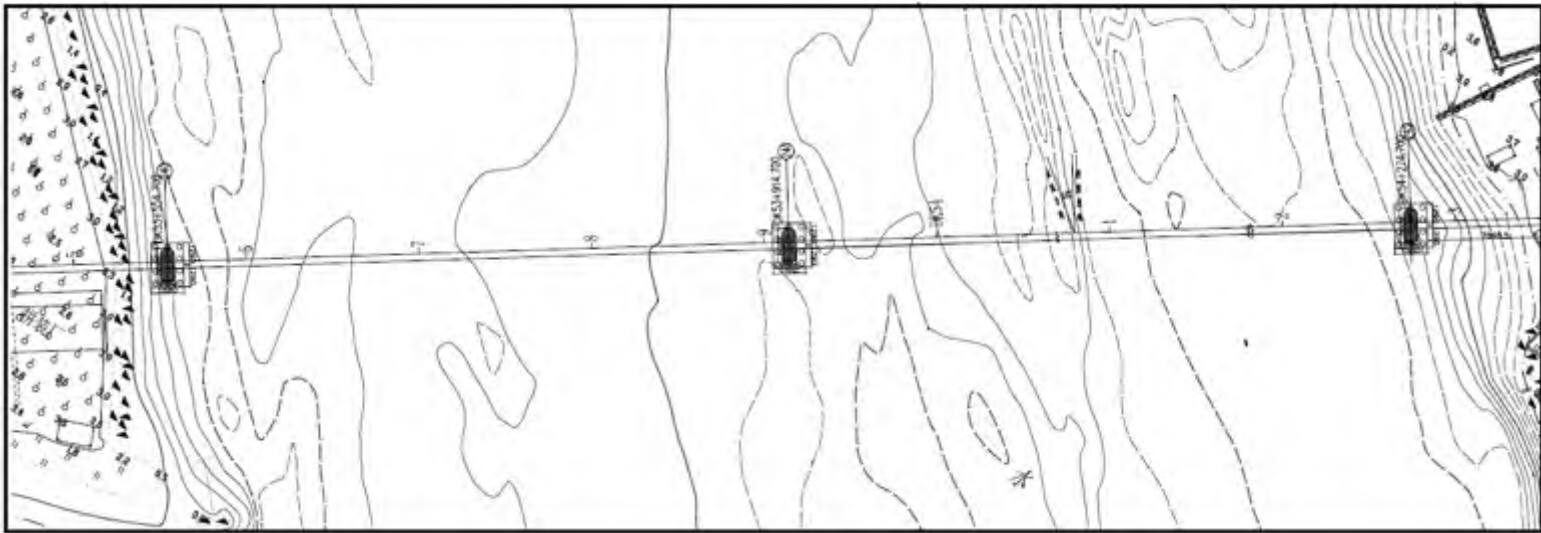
洪奇沥水道特大桥平面图（单位：cm）
